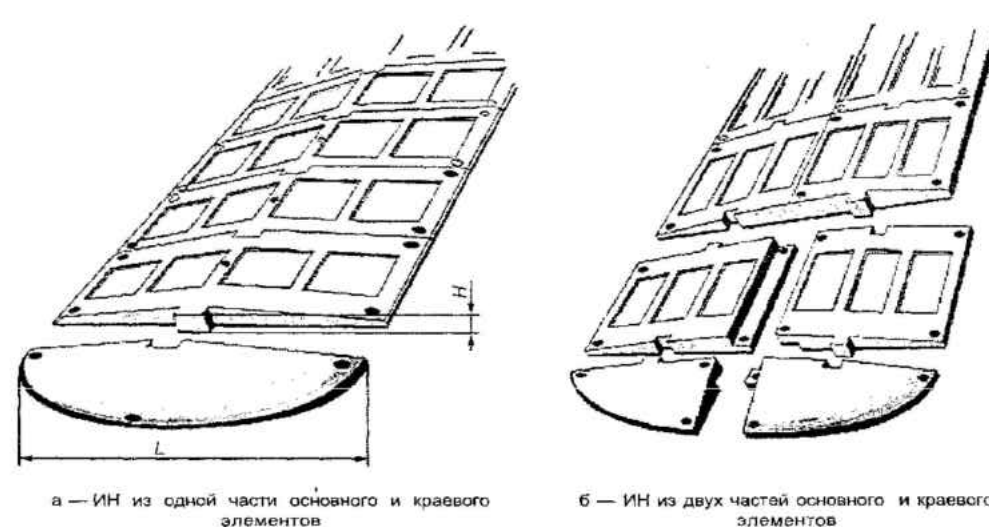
Конструкция сборно-разборной искусственной дорожной неровности
